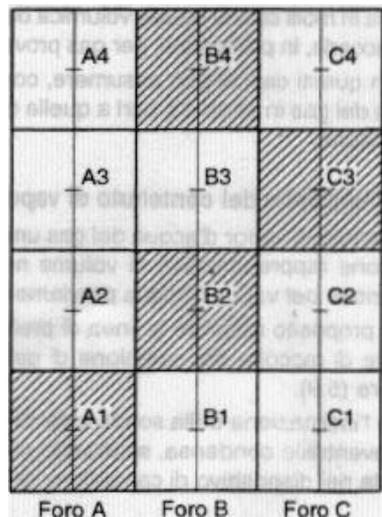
Schema di suddivisione di una sezione rettangolare.
